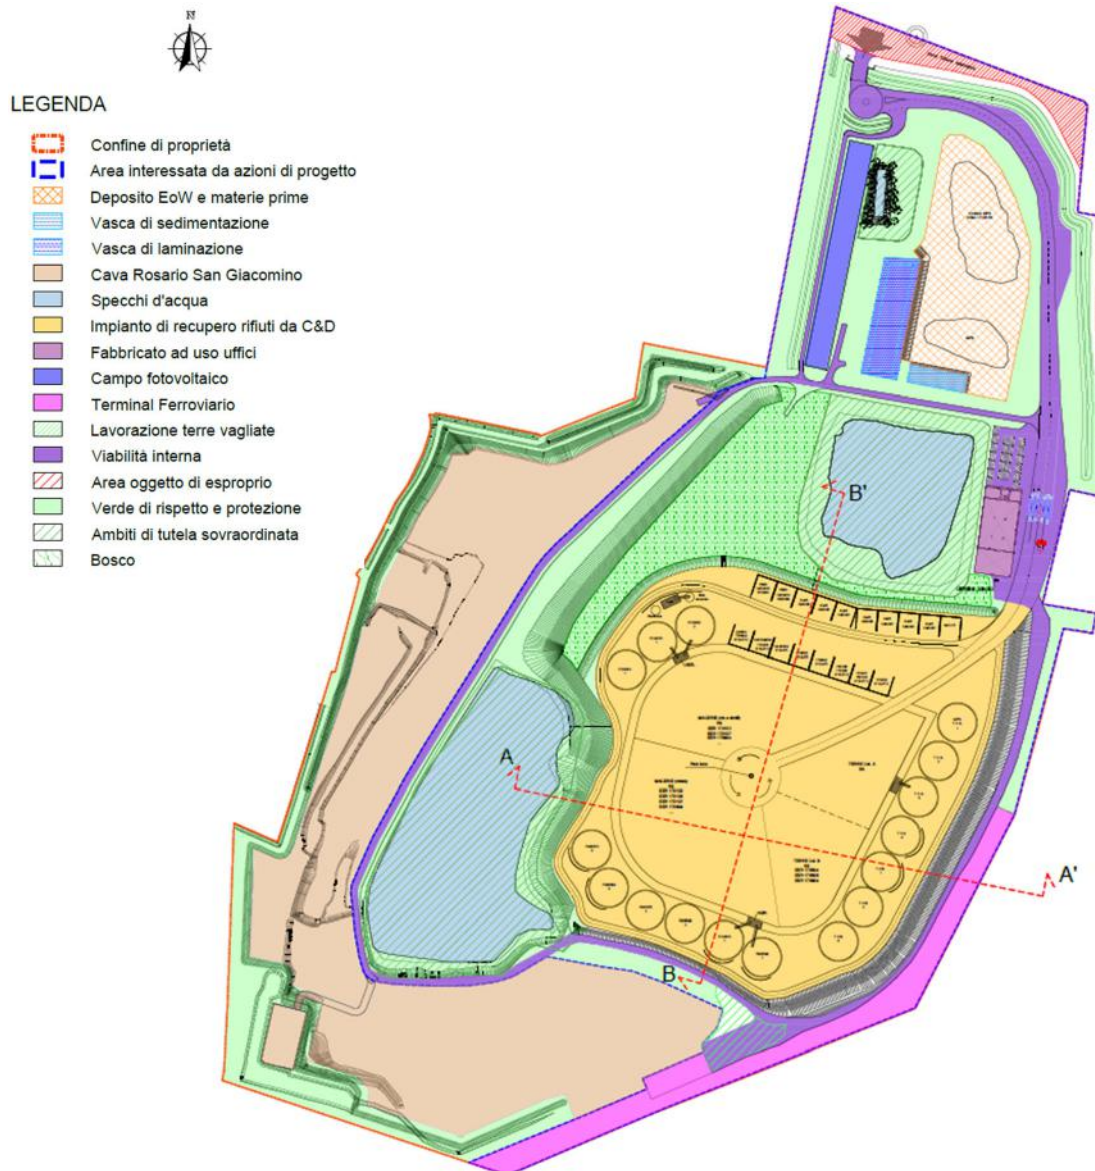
Individuazione zone funzionali “Ex Vela” (stralcio Tav. PF T11)
